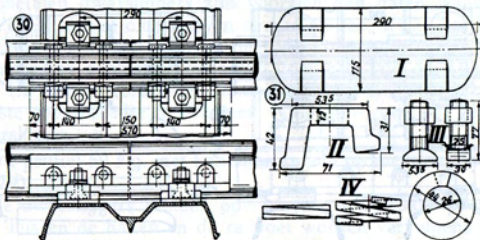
Boven- en zijaanzicht. Schaal : 1/16.
